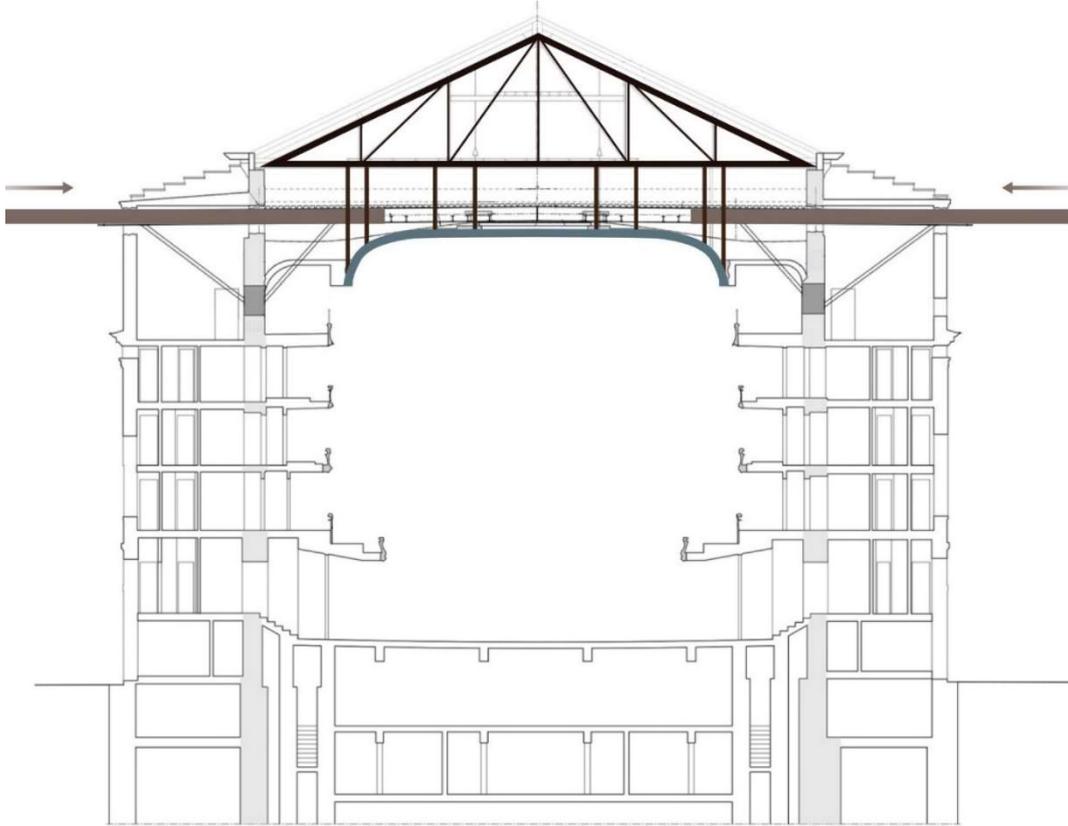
Principes pour la mise en place des nouvelles poutres soutenant le plafond existant (Greisch, 2013)
